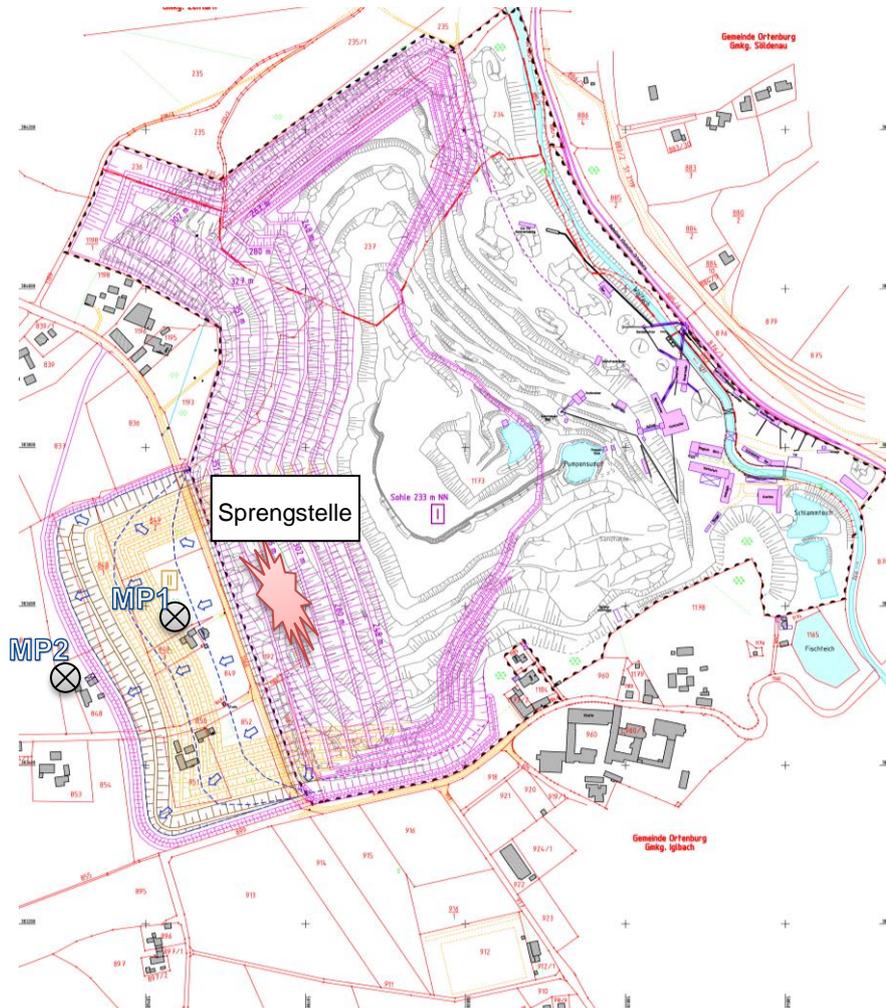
Lageplan der Steinbrucharanlage im Bestand sowie Sprengstelle und Messpunkte; geplante Erweiterung des Abbaubereichs Richtung südwesten.
